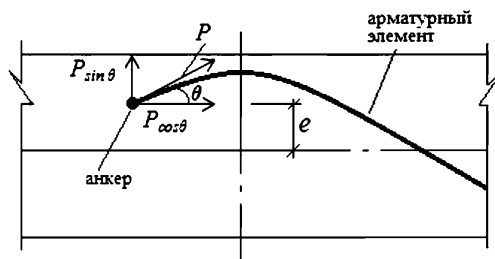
Схема установки пассивного анкера при обрыве арматурного элемента
